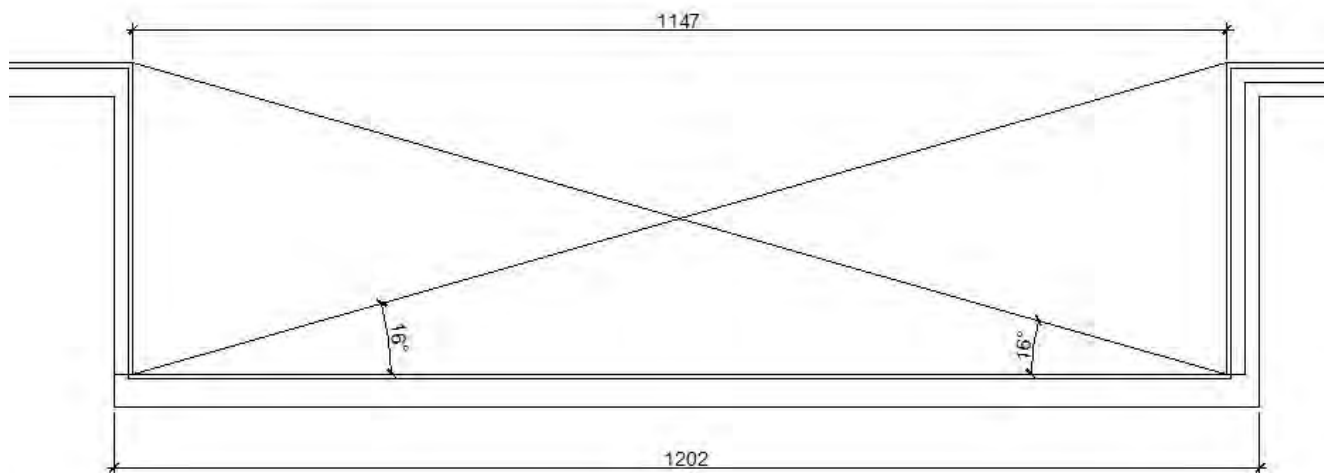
Ângulo da fachada nas janelas e porta principal (Fachada Sul).
